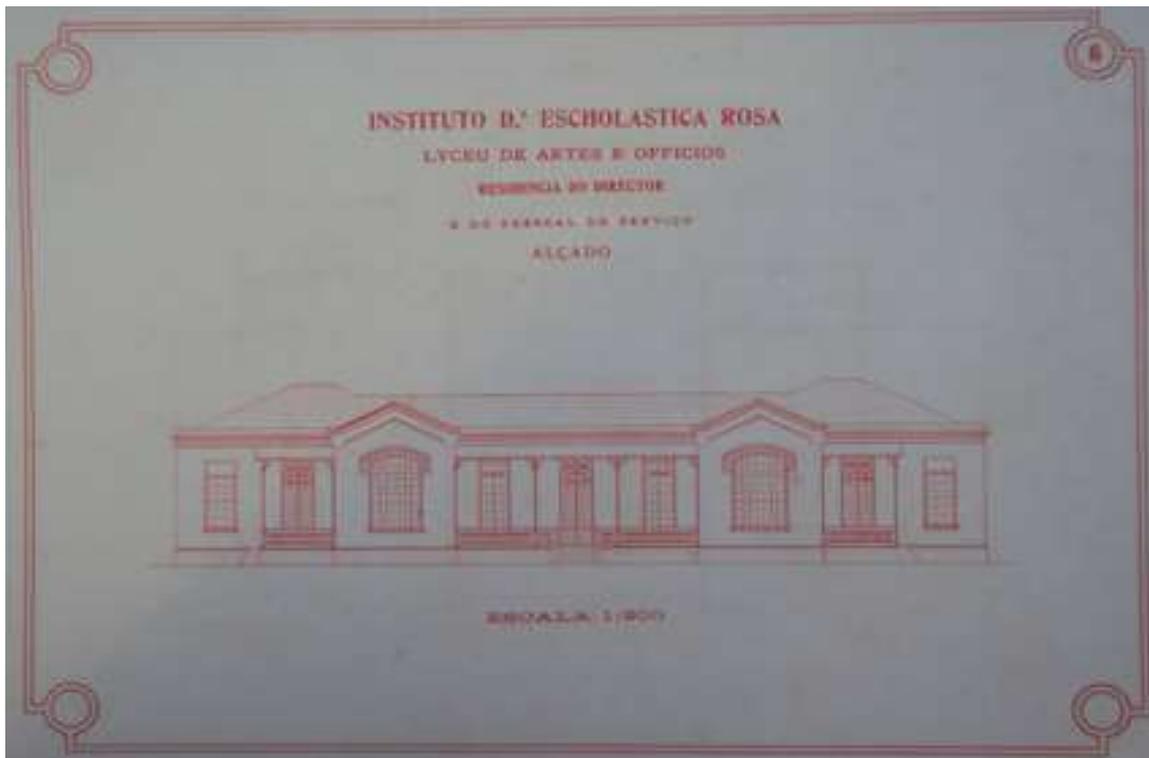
Planta 6: Fachada da residência do Diretor. Fonte: Conceição (1908)
